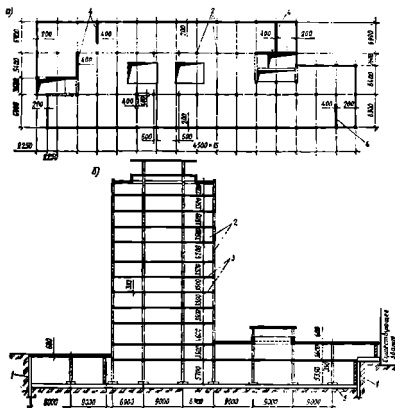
Конструктивная схема каркасного здания из монолитного железобетона:
